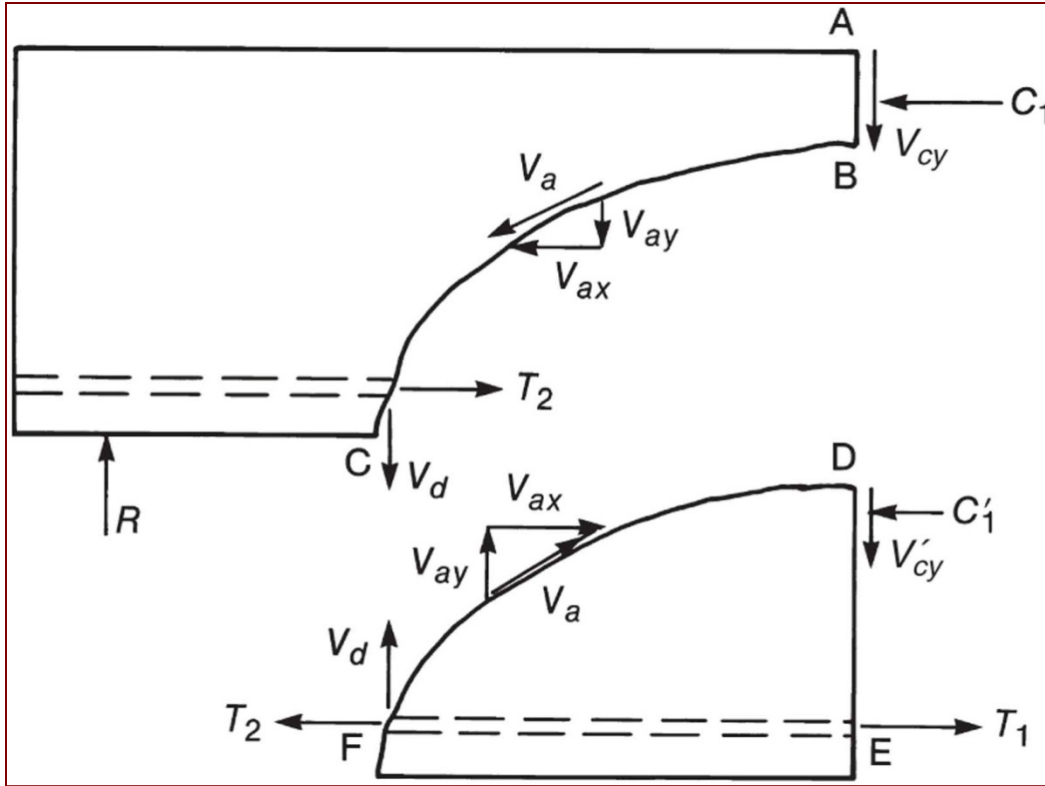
Fuerzas internas en una viga agrietada y sin estribos.
